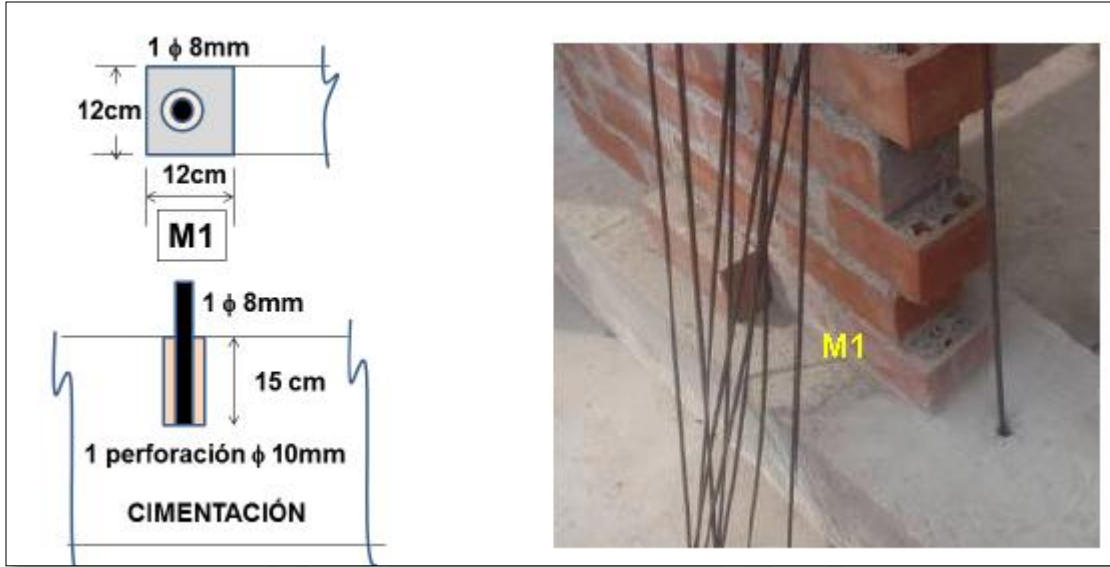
Refuerzo y anclaje en columnas del parapeto M1.
